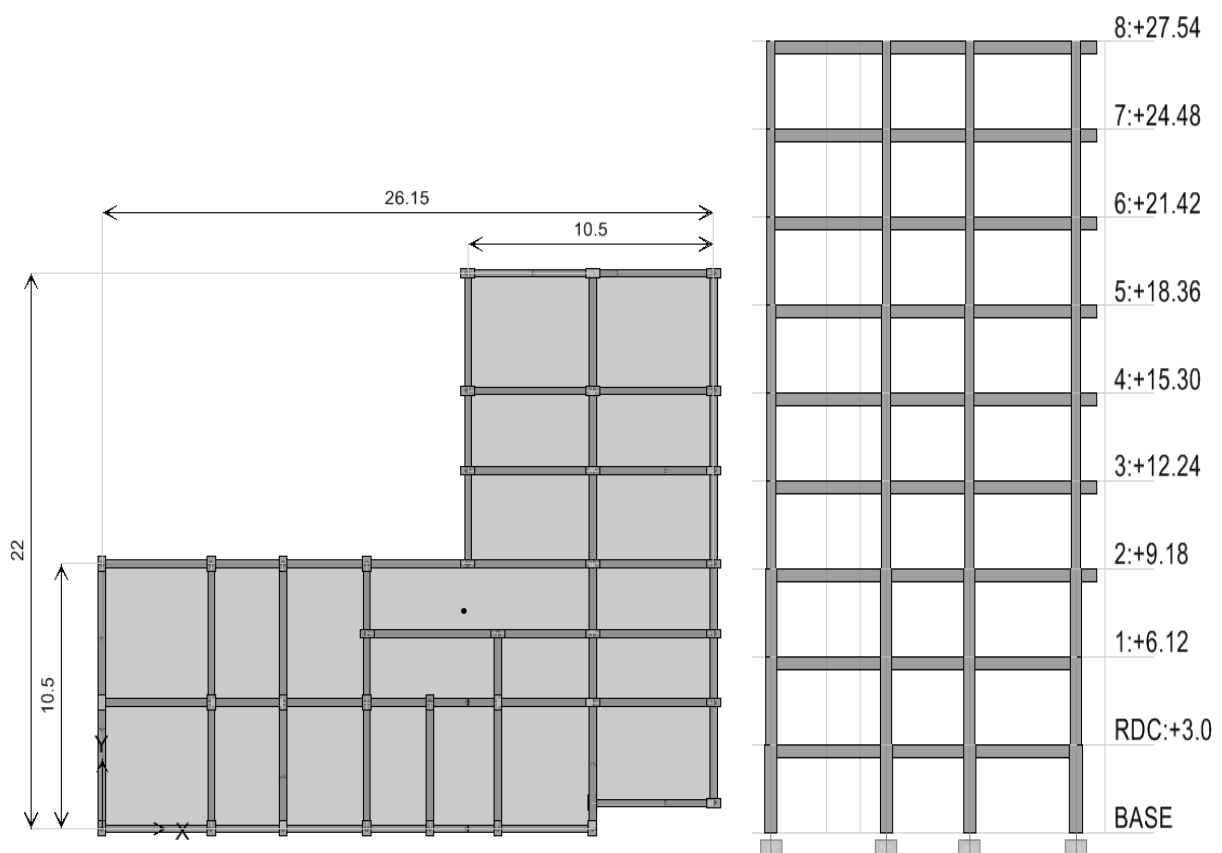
1: Caractéristiques géométriques en plan et en élévation
